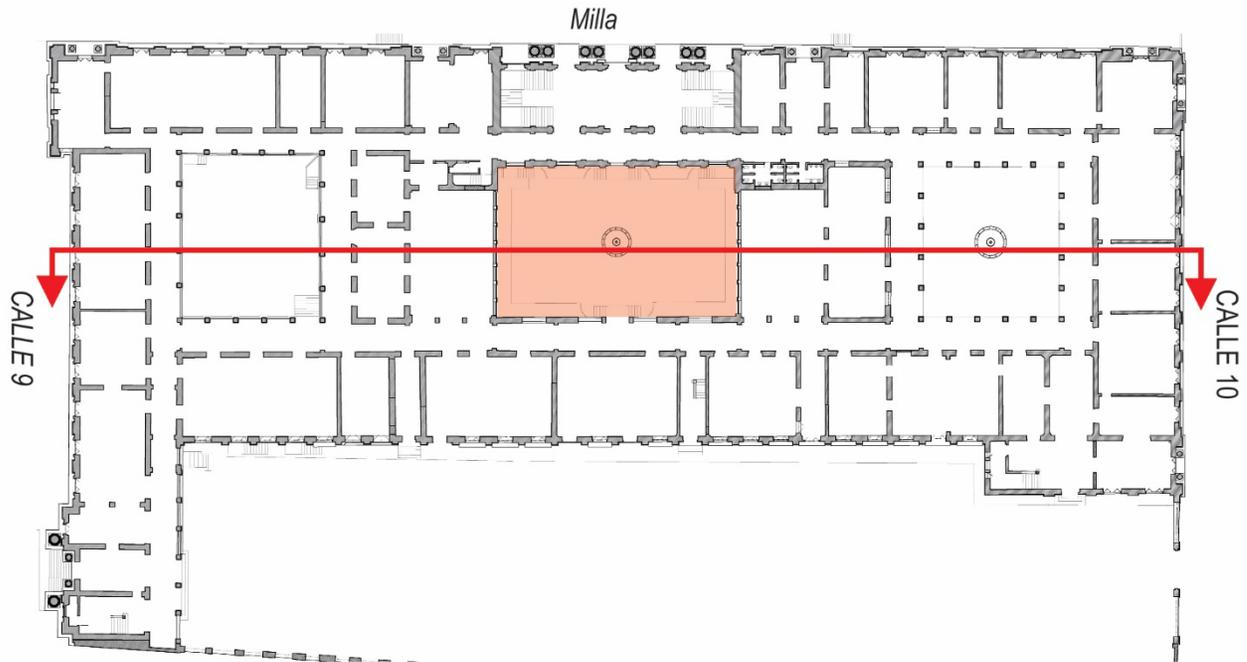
Esquema de ubicación del patio central Planta de Primer Piso
